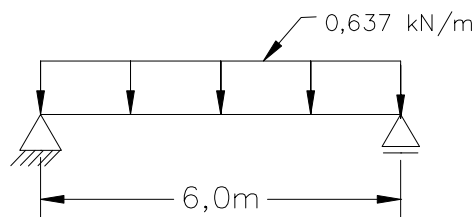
Ação da sobrecarga do passadiço sobre a viga de rolamento.
